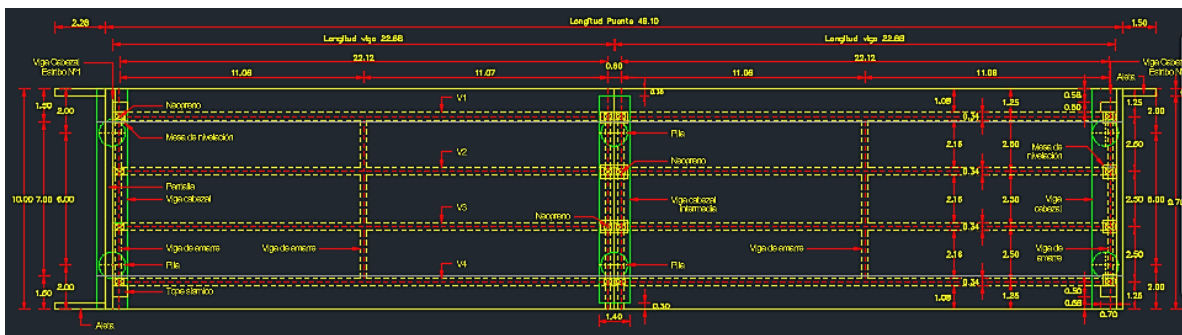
Planta puente en vigas postensadas y losa caso de estudio 3.
